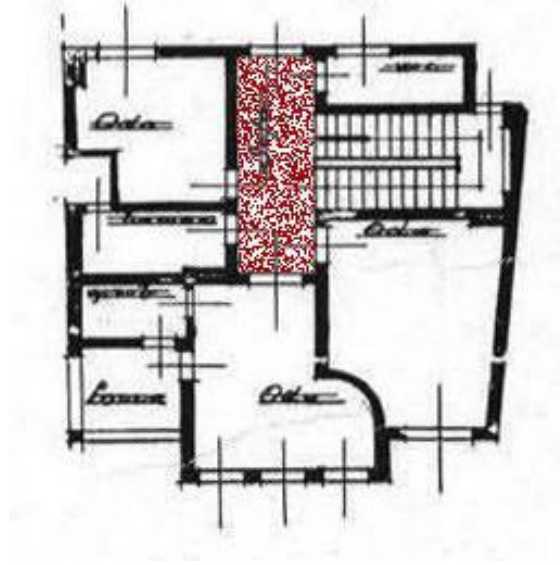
Ahmet Ağaoğlu Evi Birinci Kat Planı (Sofalı Ev Planı)
